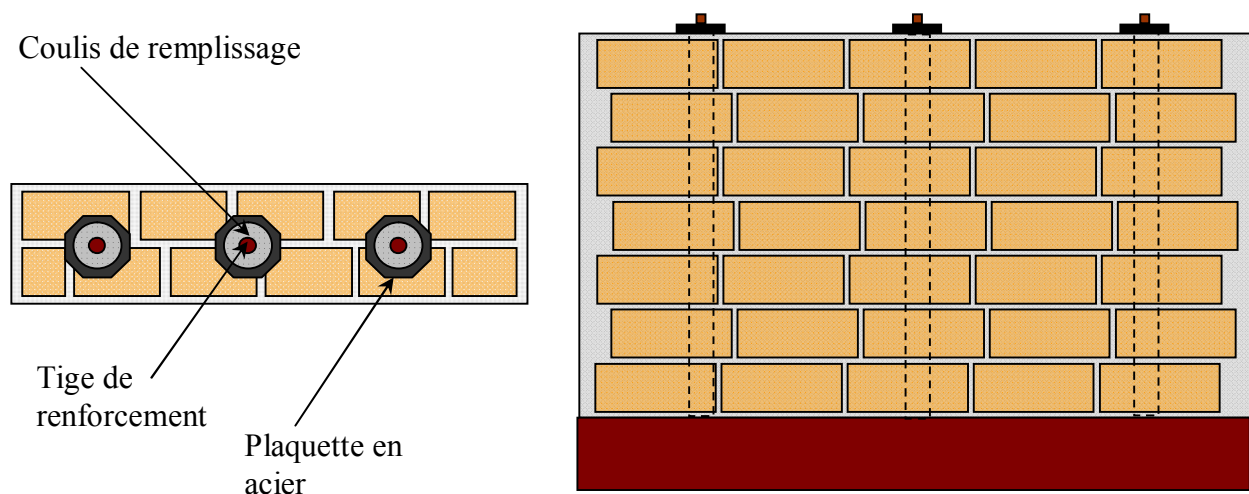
Coupe transversale et verticale d'un mur en maçonnerie renforcé par des tiges ancrées
